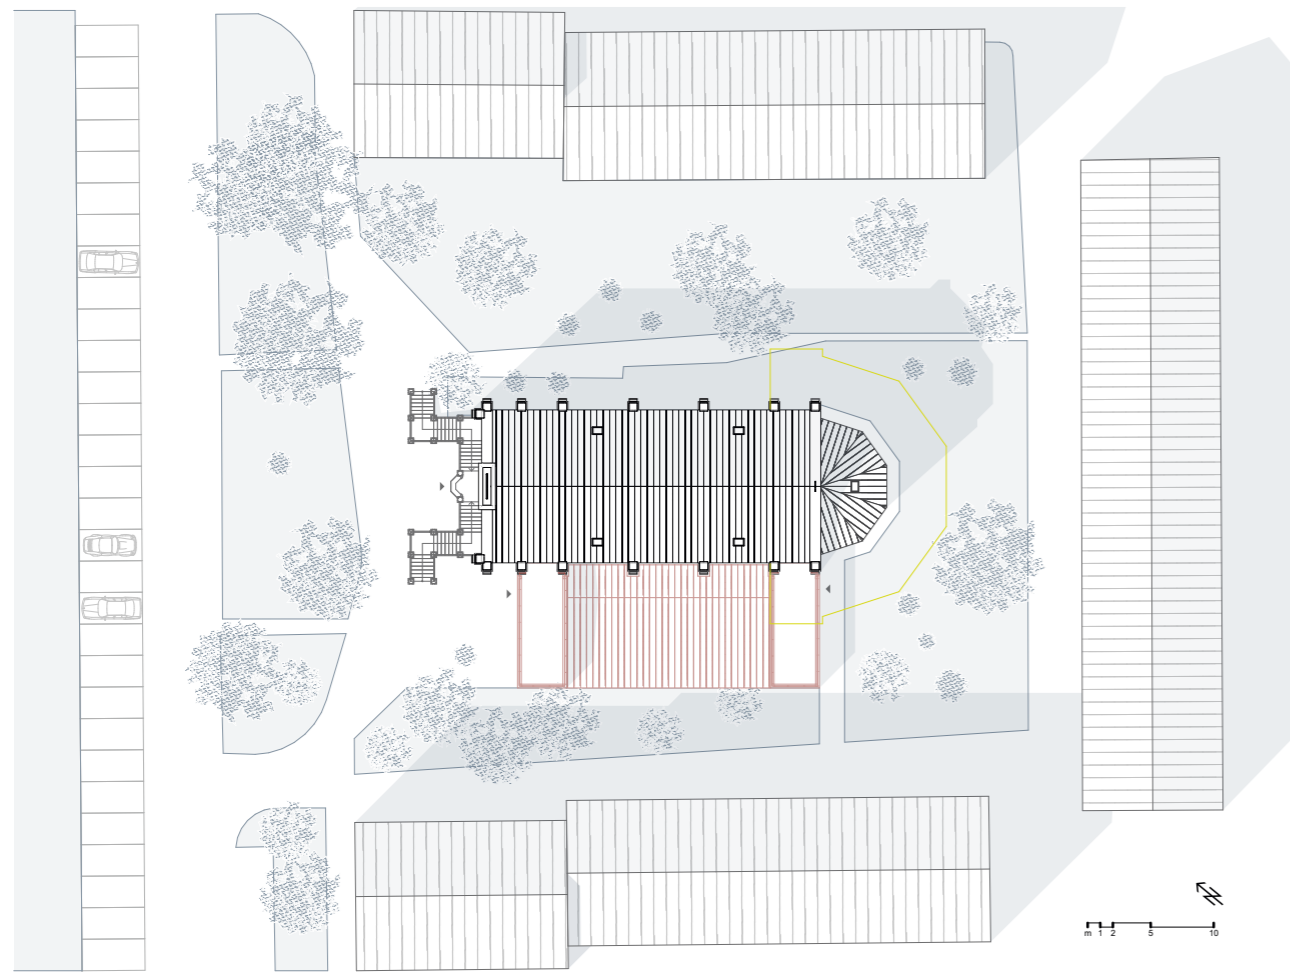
Ausführung 2: Lageplan in rot (Neubau) und gelb (Abbruch)
